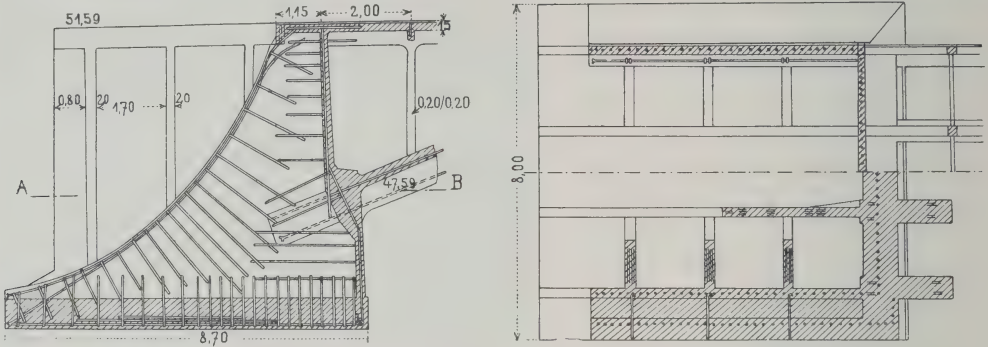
Querschnitt und Grundriß des Widerlagers zu Châtellerault.
